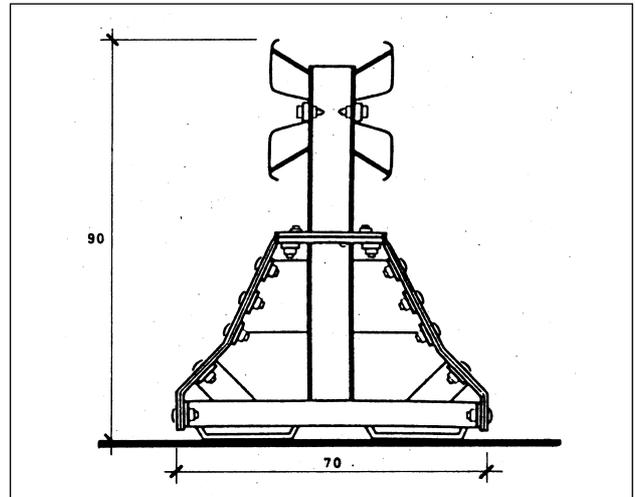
sezione trasversale di una barriera di sicurezza in acciaio Vecu-Sec
